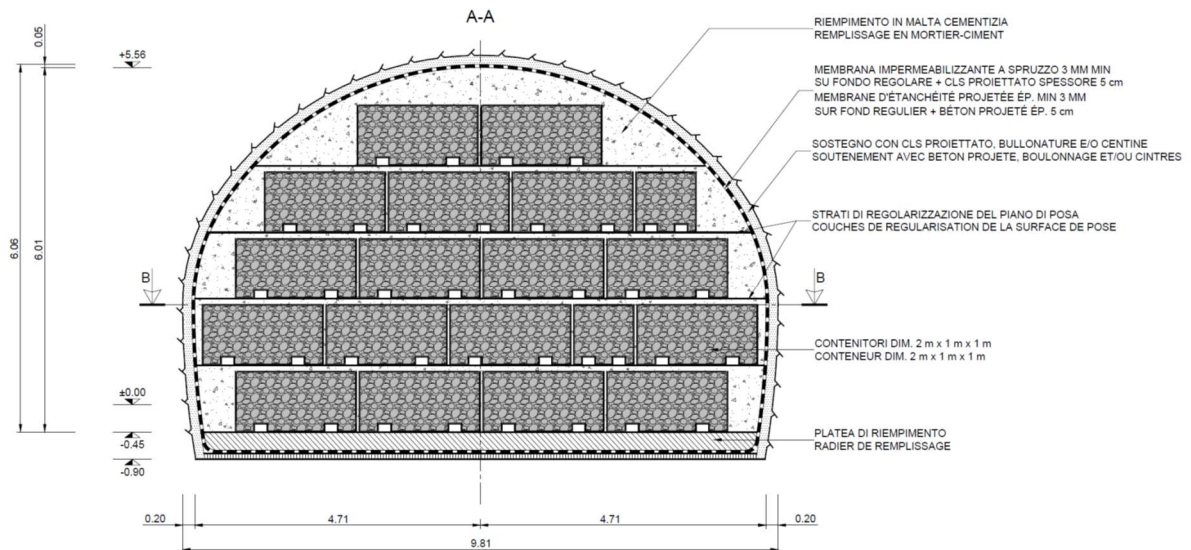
Sezione di stoccaggio nella sezione corrente di Maddalena 1bis (PRV_C3A_7554_26-48-10)
